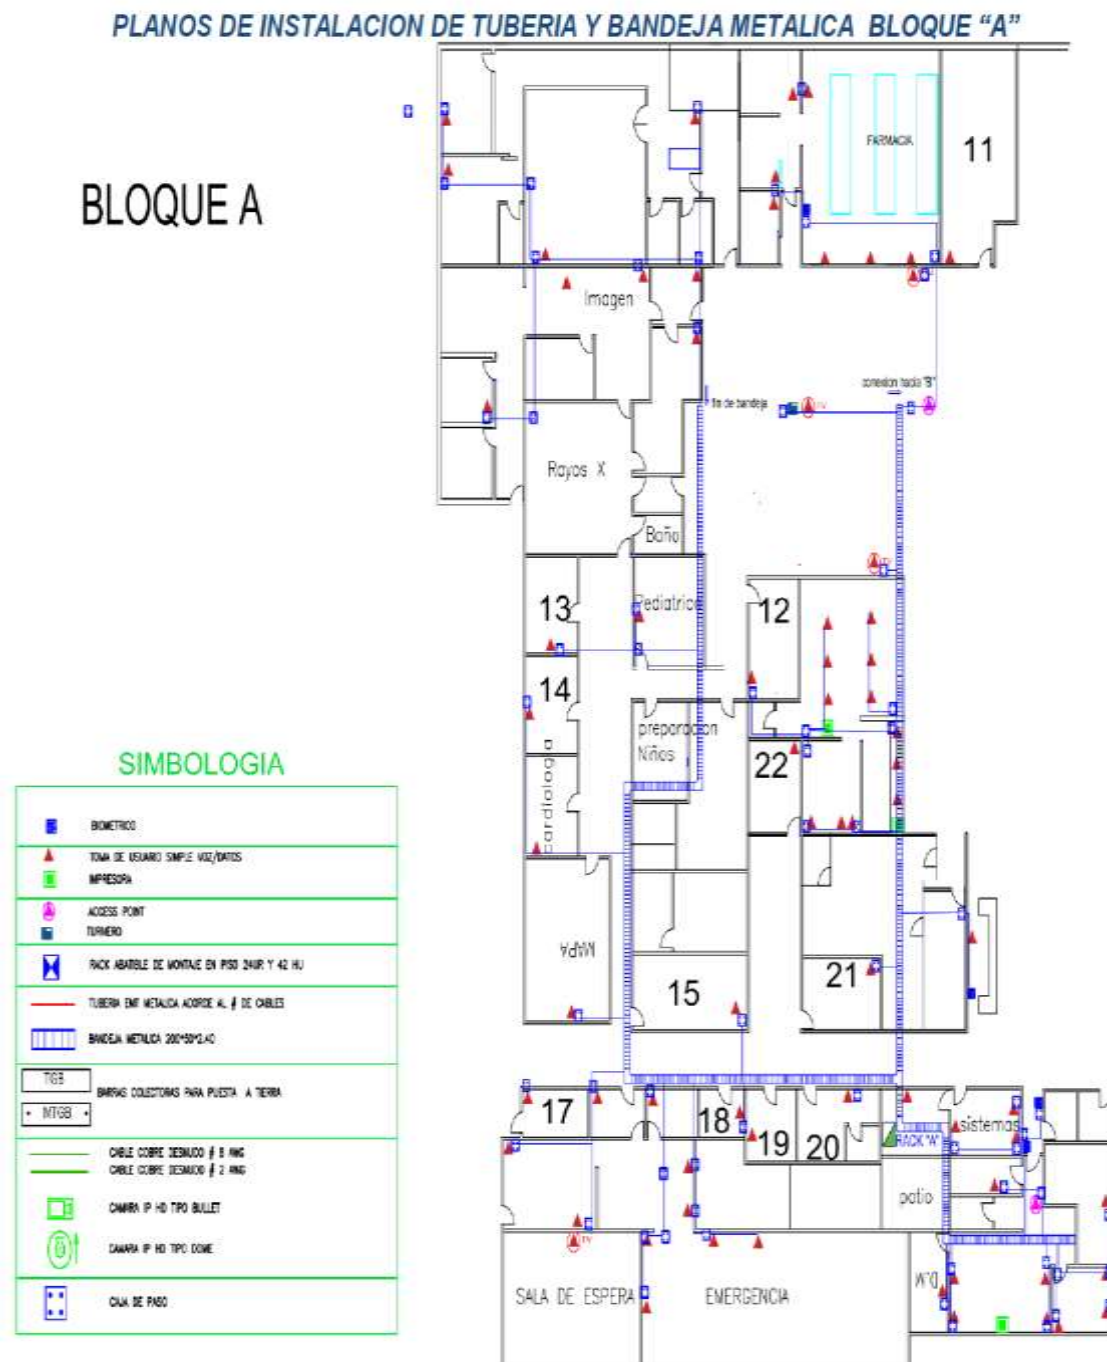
Bloque A, recorrido bandeja metálica y tubería EMT.
